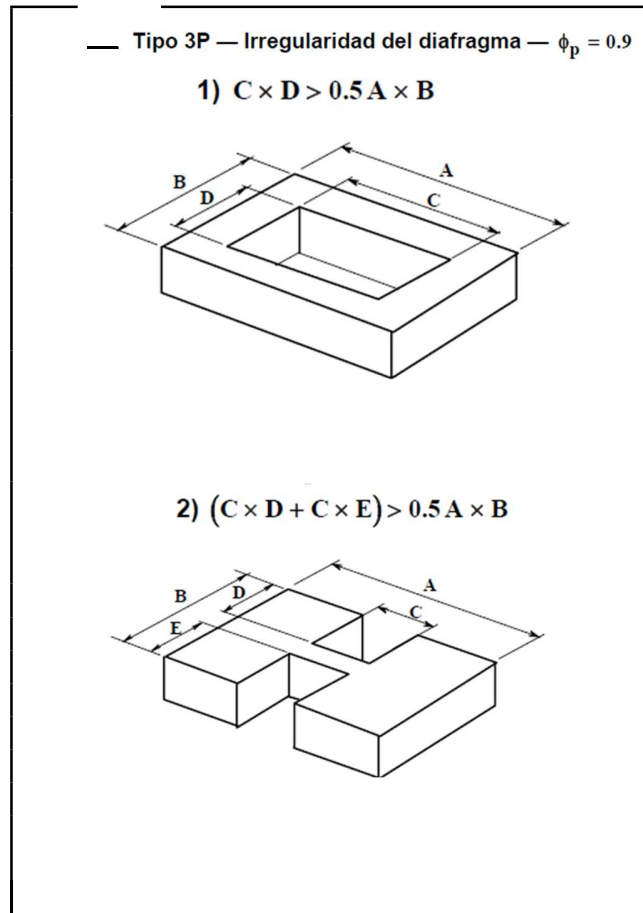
VISTA DE PLANA - PLANTA IRREGULAR
